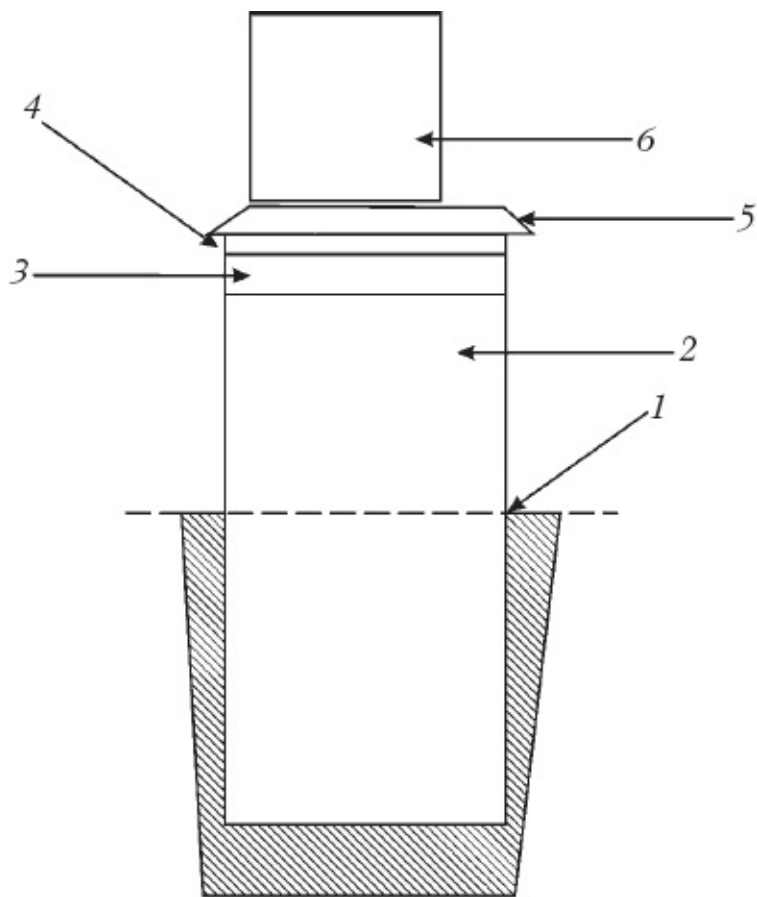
Гидроизоляция фундамента: 1 – уровень земли; 2 – столб или лента фундамента; 3 – цементно-песчаный раствор; 4 – битум; 5 – рубероид; 6 – закладной брус
